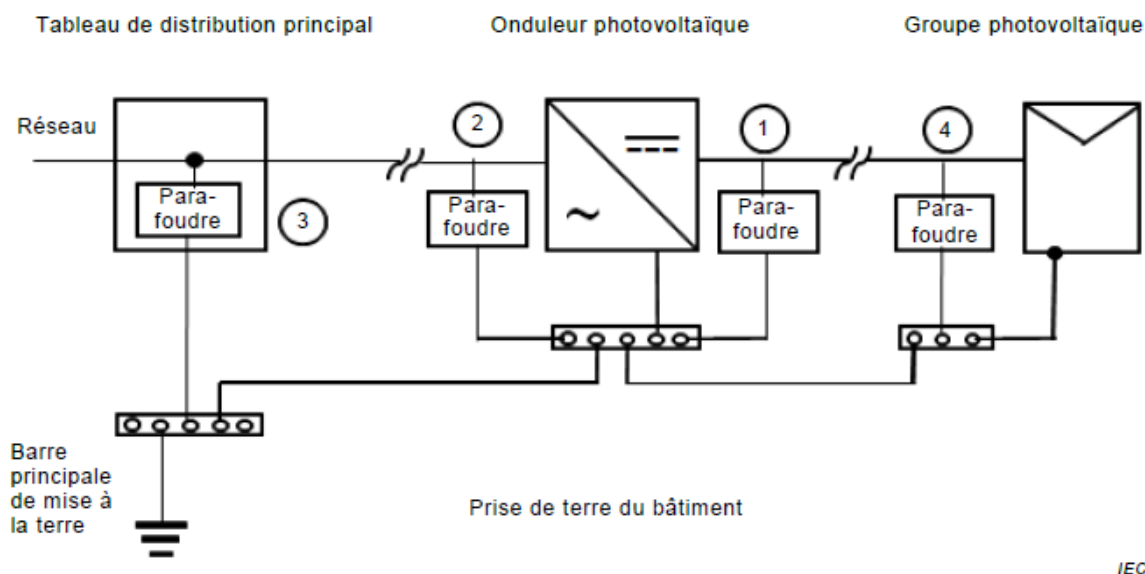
Installation des parafoudres dans le cas d'un bâtiment sans installation extérieure du système de protection contre la foudre
